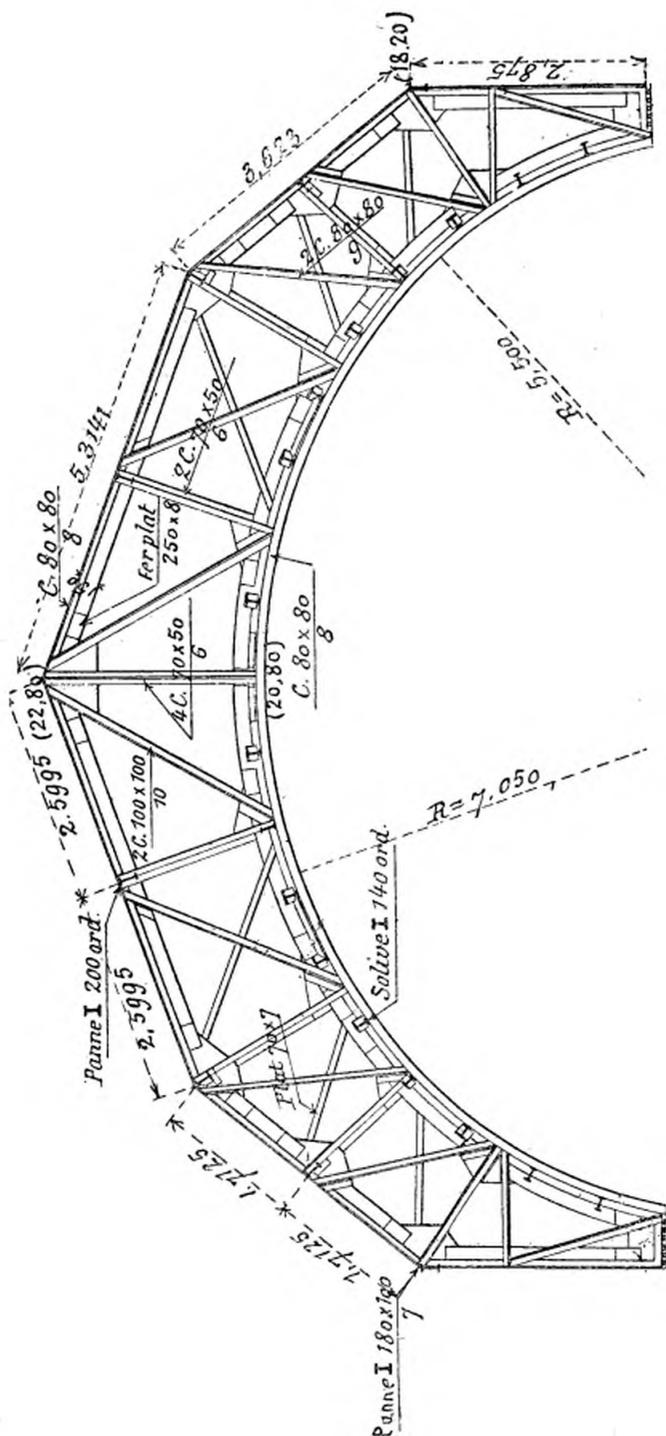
Elevation d'uneferme de la galerie de la façade principale. — Echelle de 0<sup>m</sup>,01 pour 1<sup>m</sup>,00.
